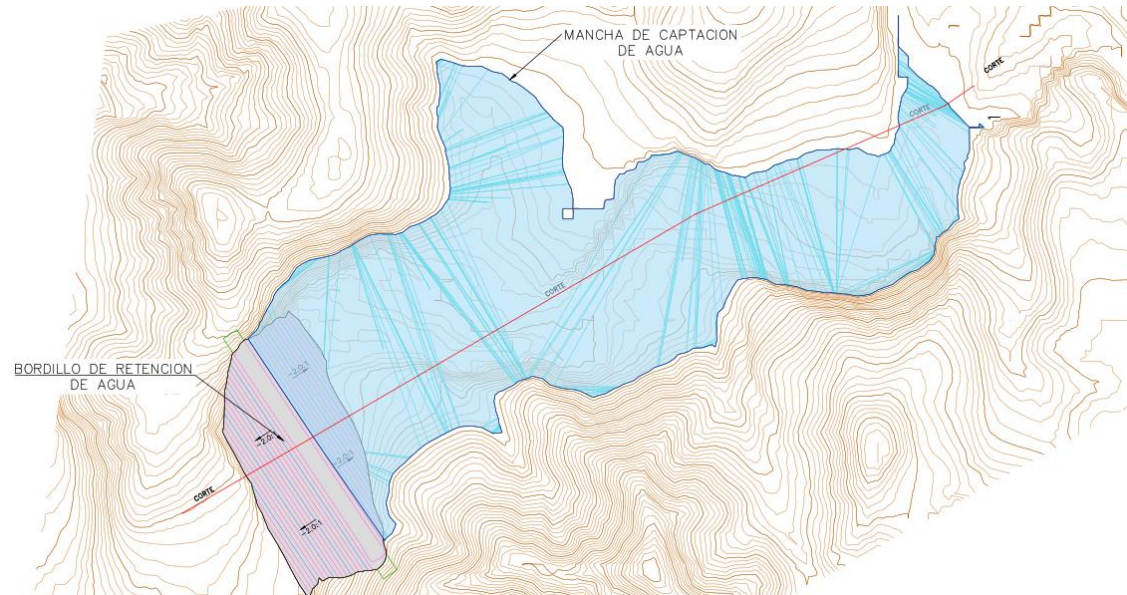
Vista en planta Bordo y área de captación de sedimentos.
